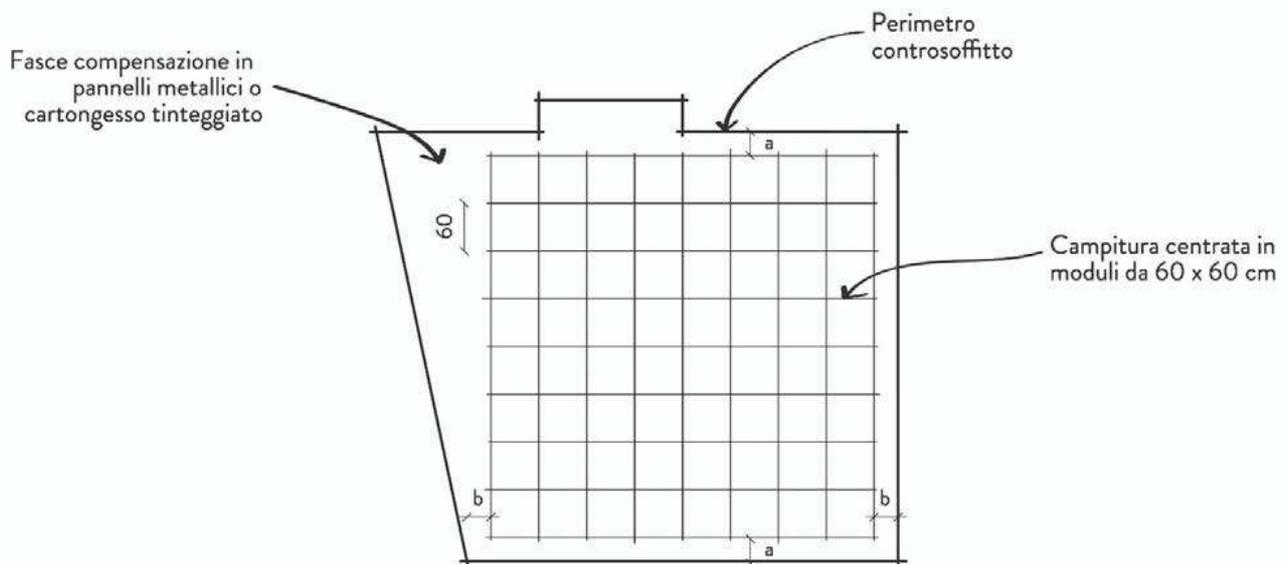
Schema di disposizione dei pannelli a controsoffitto
